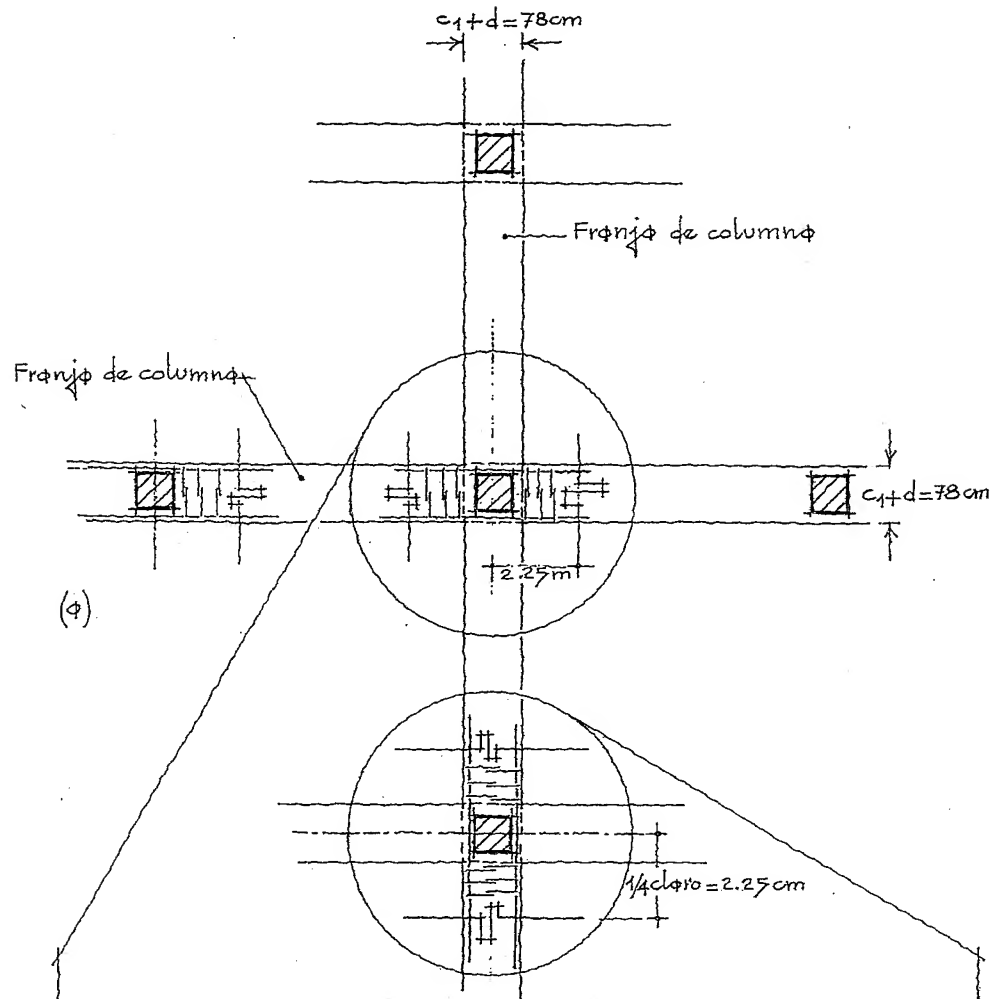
Franja efectiva de columna vista en planta, (b).
